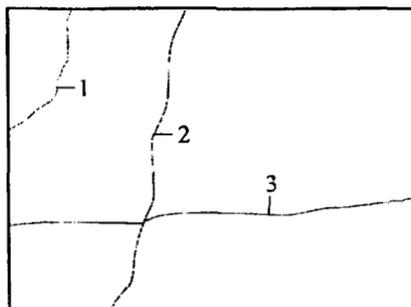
Разрушающие воздействия на цементобетонное покрытие
